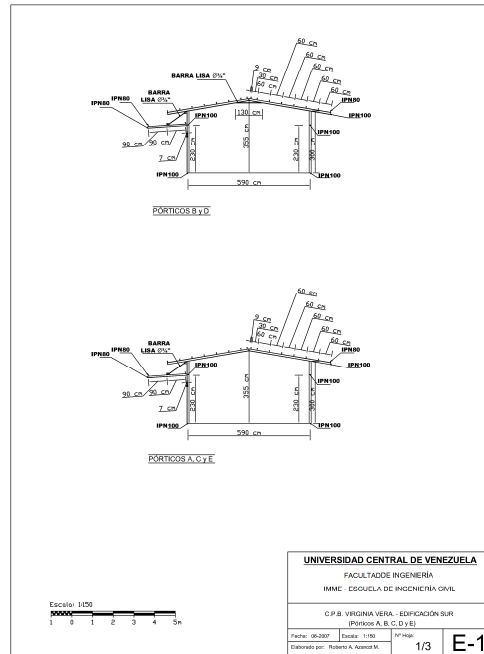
Plano E1: Plano Estructural de los pórticos A, B, C, D y E
